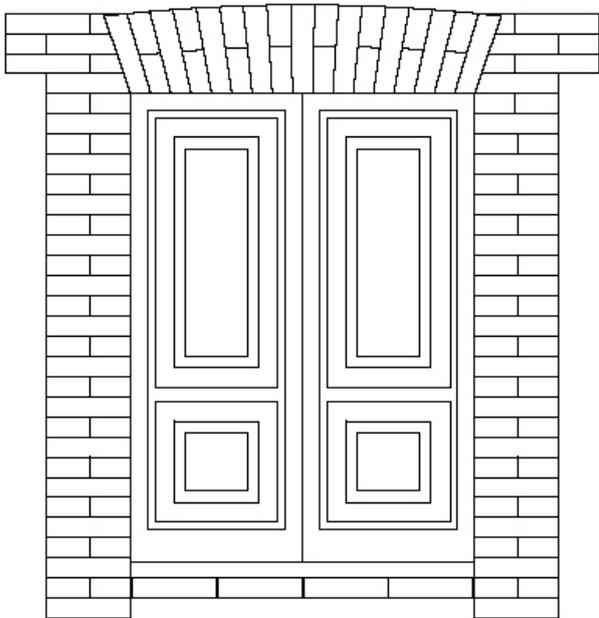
Finestra piattabanda e spallette di laterizi pieni
